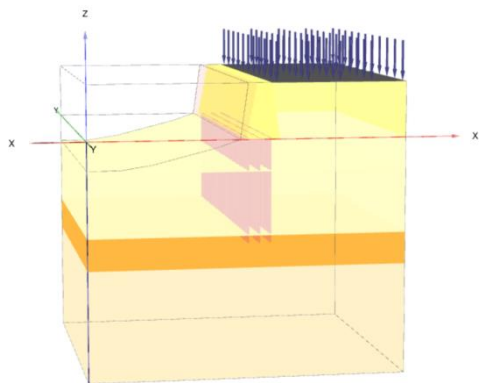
Расчетная схема устойчивости набережной р.Мойка до утраты оголовков свай
